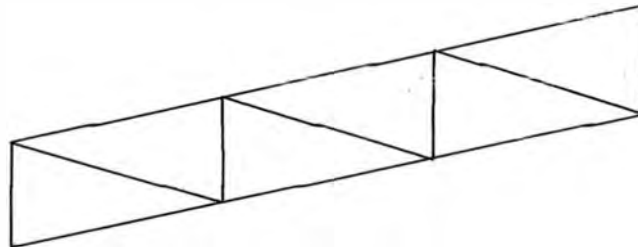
Estructura de cercha. a- Columna. b- Viga. c- Cumbrera
